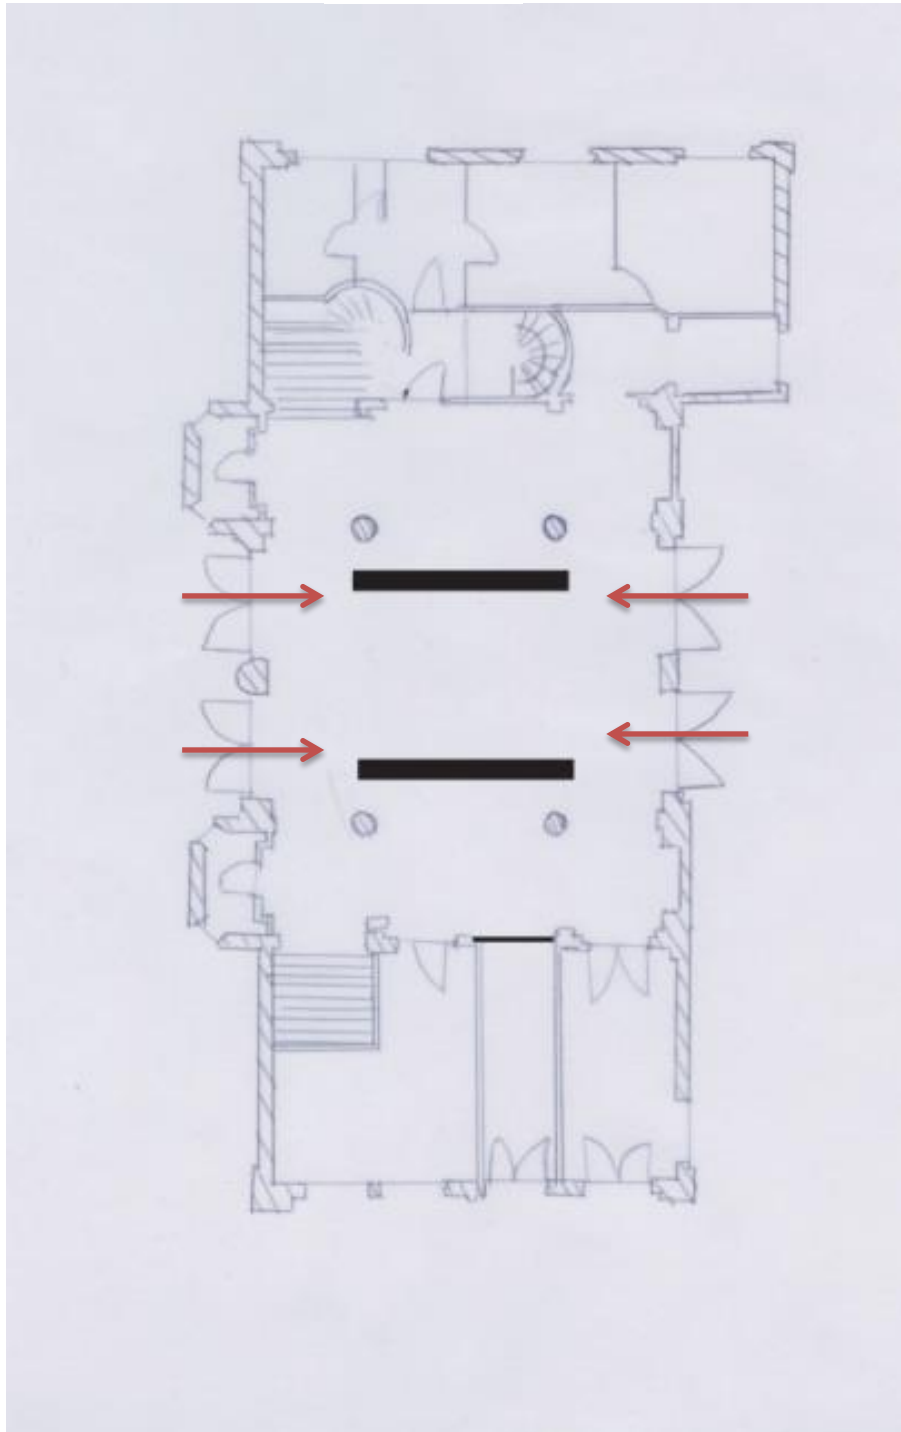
Plan fonctionnel du rez-de-chaussée avant sa fermeture -
